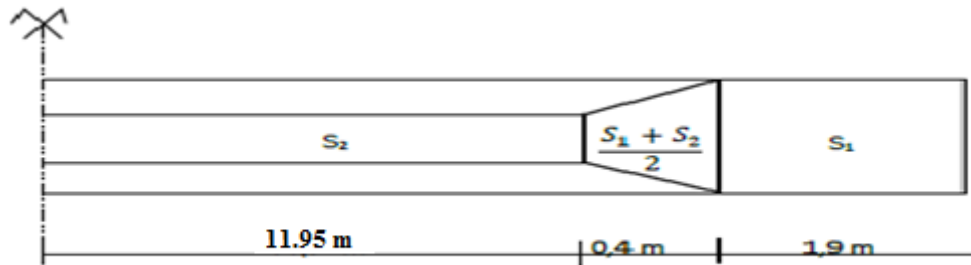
Vue latérale de la poutre en béton précontrainte
